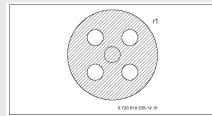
Sondenquerschnitt einer Doppel-U-Sonde mit Verfüllrohr
